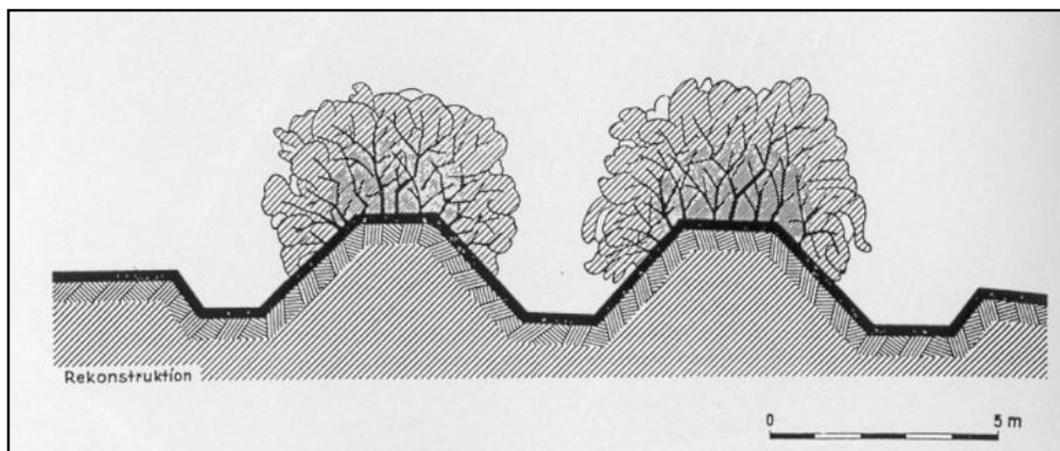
Schemaschnitt Landwehrkonstruktion
